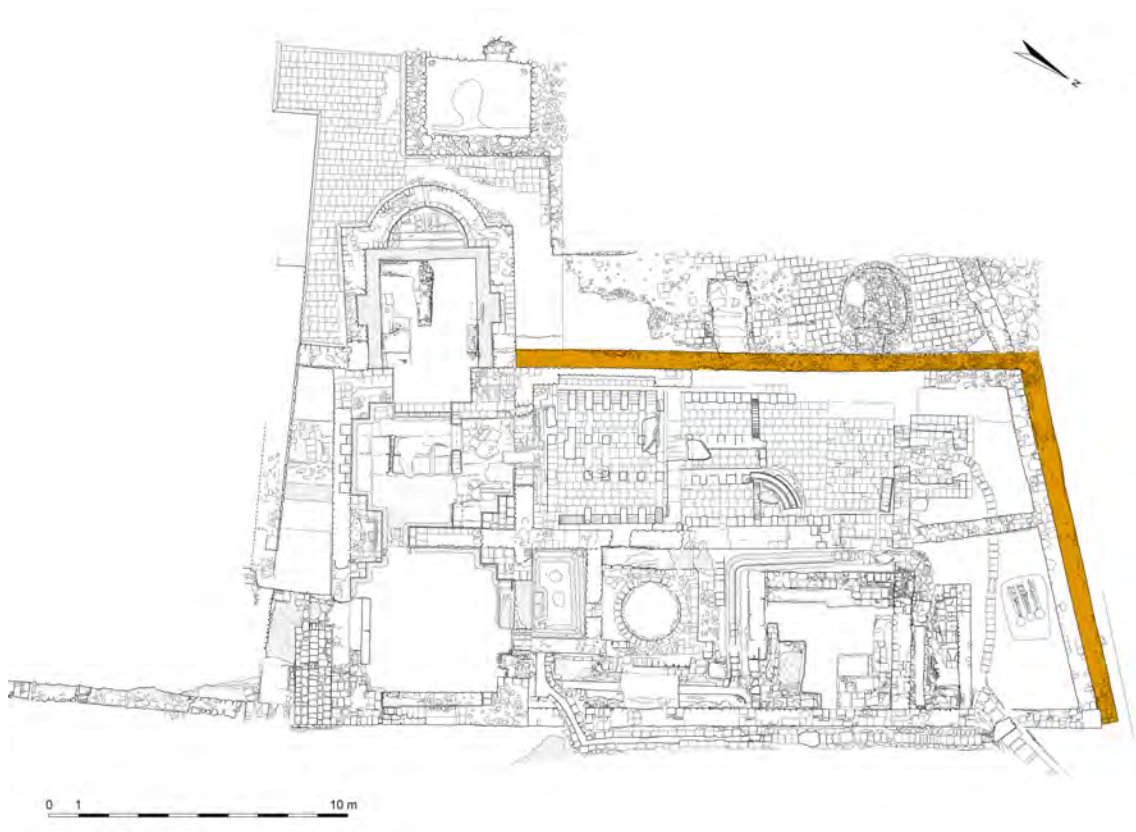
Planimetría de las termas públicas de *Munigua* donde se destaca el muro perimetral, identificado como una evidencia de la planificación del inmueble. Elaboración propia a partir de planimetrías del Instituto Arqueológico Alemán (Fuente: T. Schattner)
